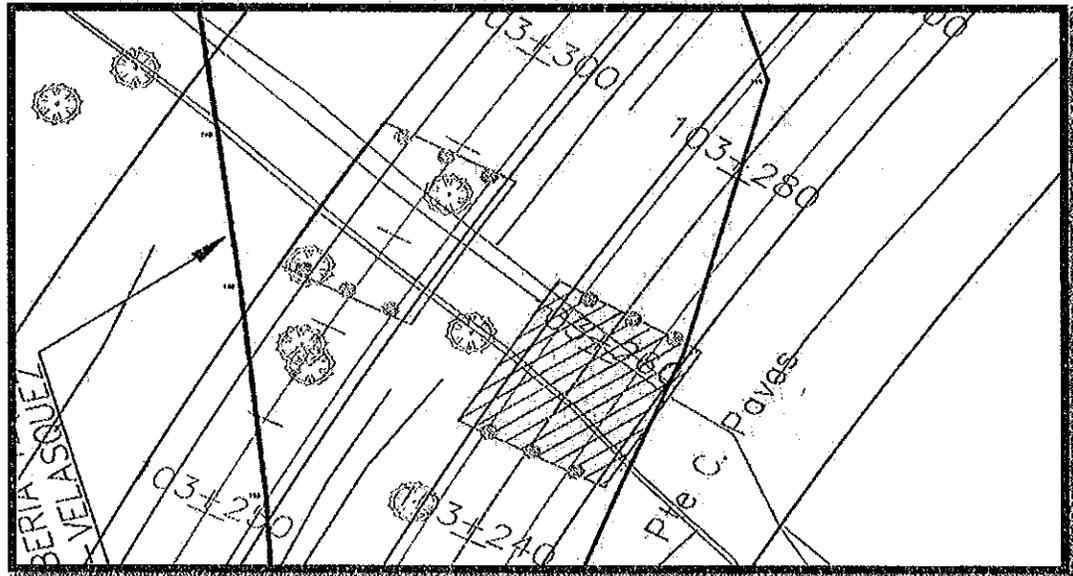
acercamientos críticos con estructuras viales (Puentes) e infraestructura petrolera
